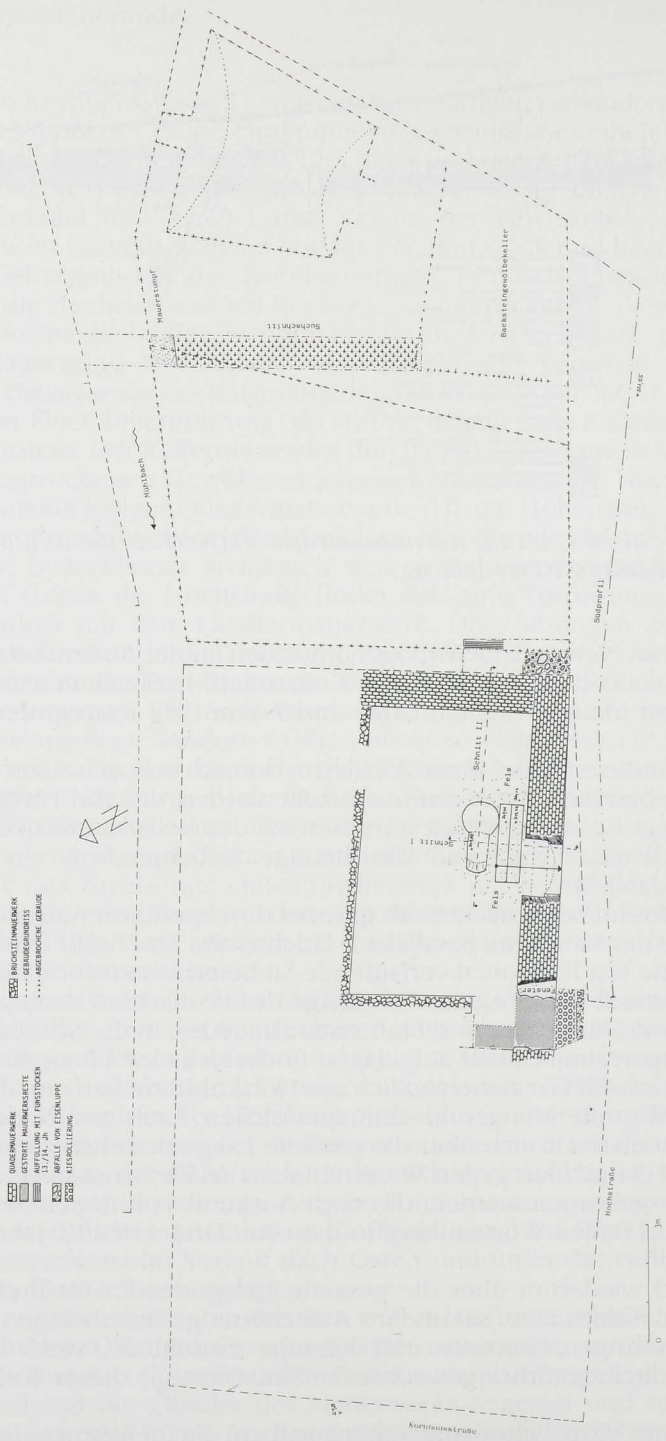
Schwäbisch Gmünd, Kornhausstraße 21/Hochstraße 1-3, Grundriß-Situationsplan.
